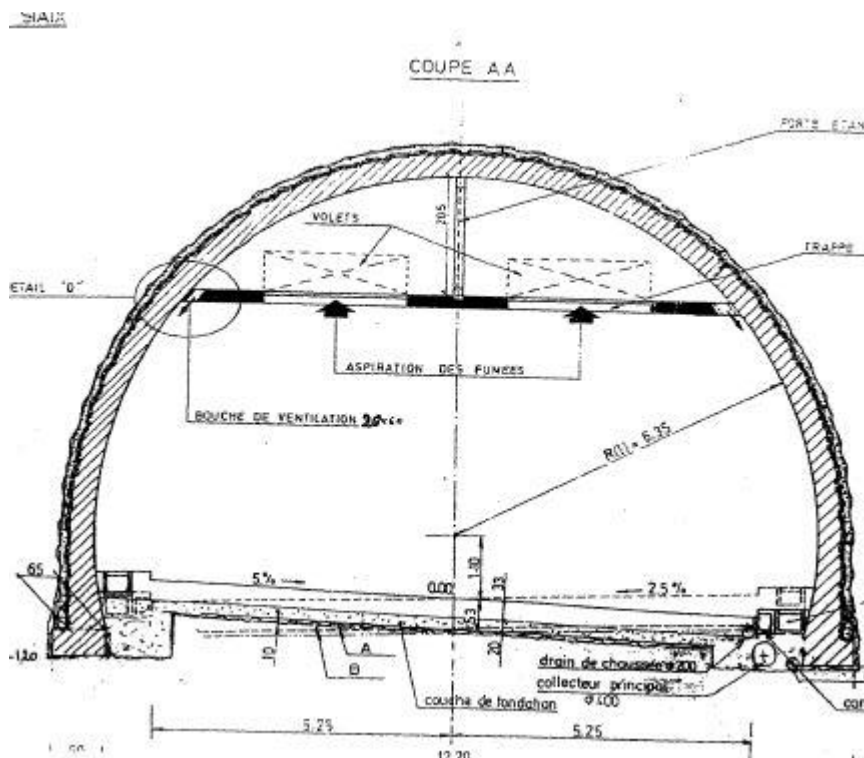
Coupe du tunnel du Siaix (la dalle de ventilation est située en hauteur)
